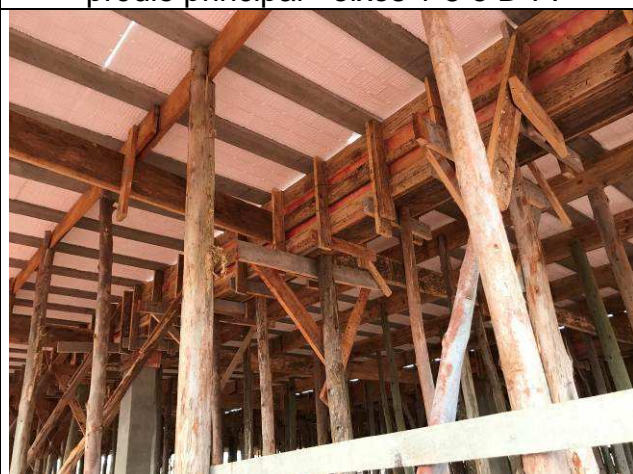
C: Laje e vigas de cobertura do prédio principal - eixos 1-5 e D-F.
